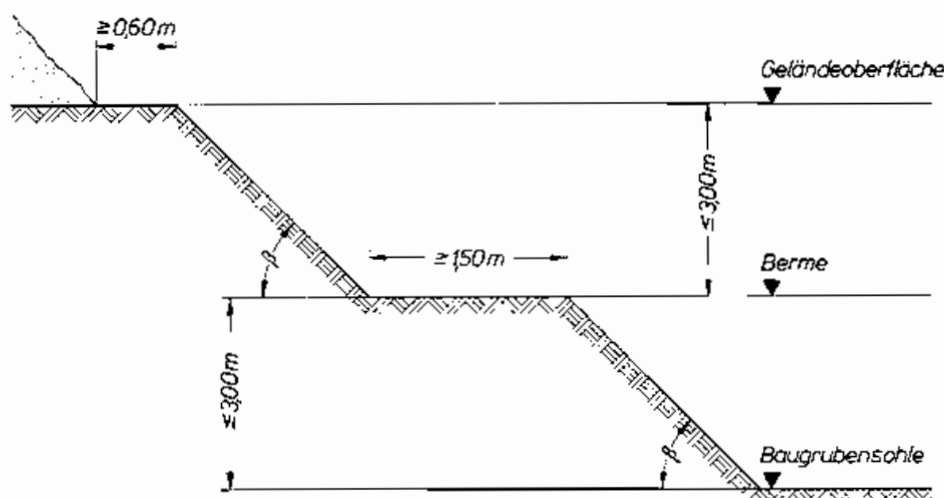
Baugrubenböschung mit Berme zum Auffangen abrutschender Teile
